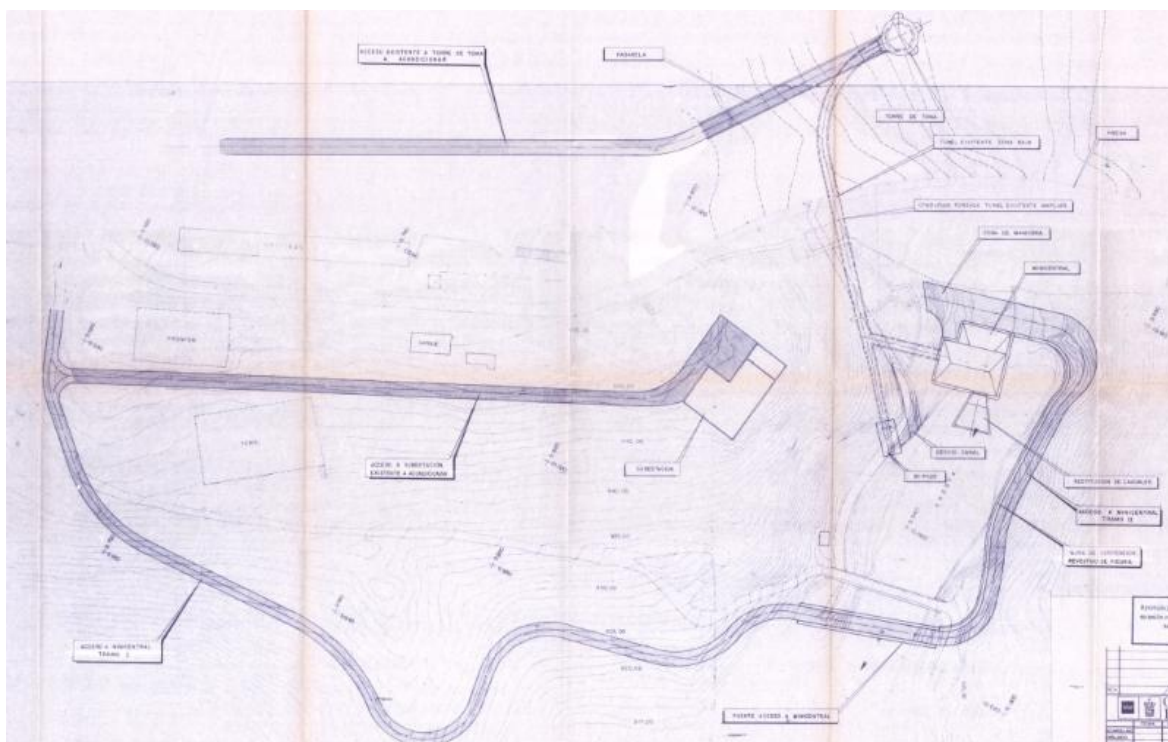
Ordenación del PE de de la minicentral hidroeléctrica. Fuente: •Plan Especial para el Proyecto de suministro, montaje, construcción y puesta en marcha de la minicentral hidroléctrica en la presa de el Villar del Canal de Isabel II en el Río Lozoya
